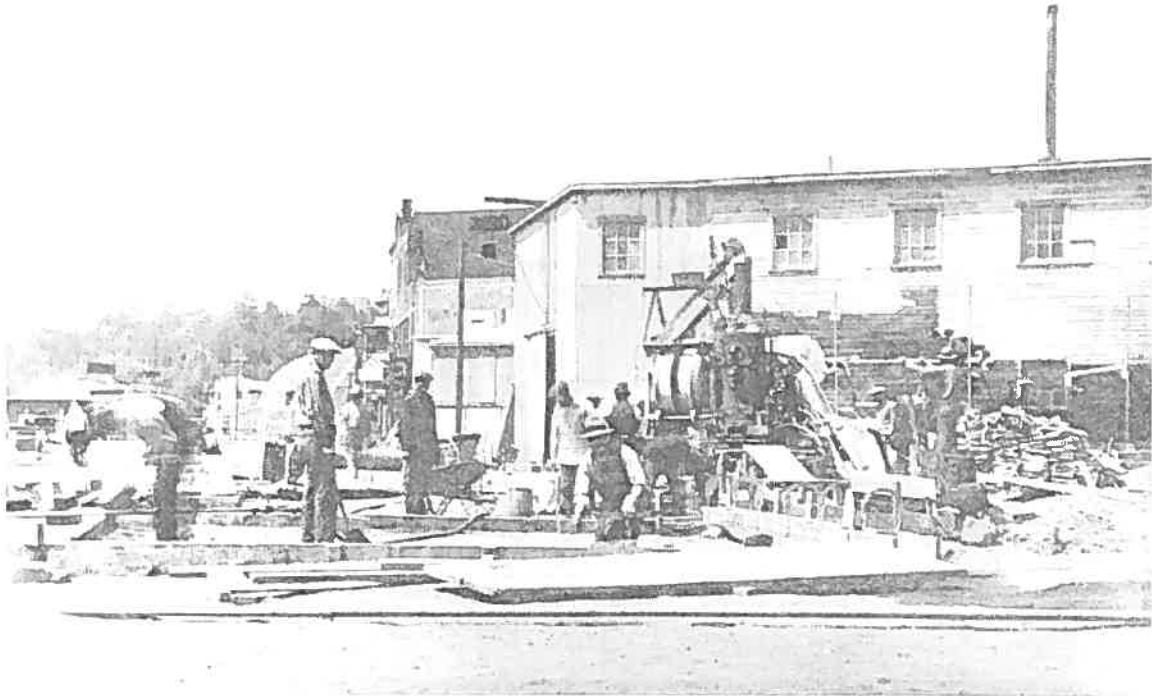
Travaux de pavage et d'embellissement du boulevard Saint-Maurice
